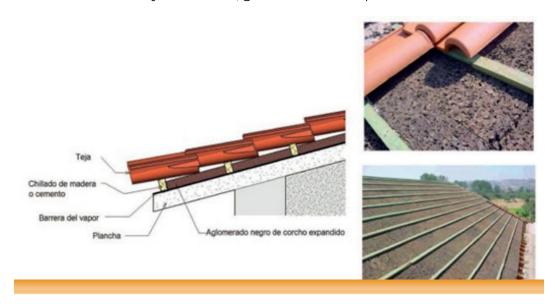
Aislamiento de cubiertas mediante corcho aglomerado. Fuente: THERMACORK www.aislamientocorcho.es
